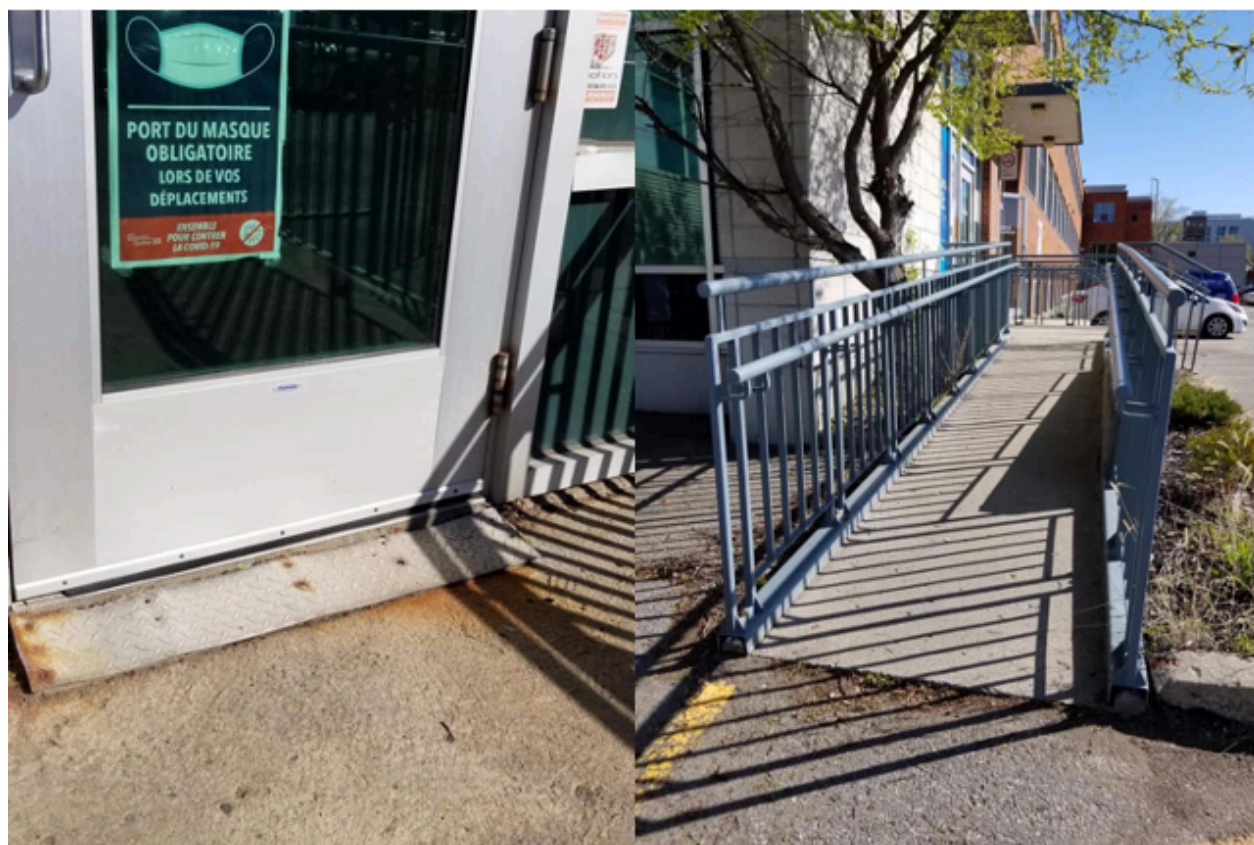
La rampe d'accès et la rampe de seuil de porte au travail de Geneviève
